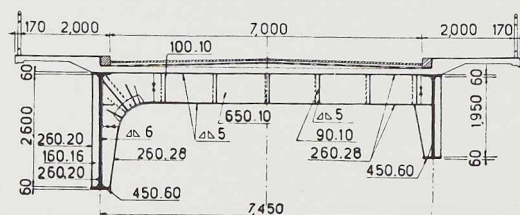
Coupes transversales. A droite : à l'appui. A gauche : au milieu de la travée.
